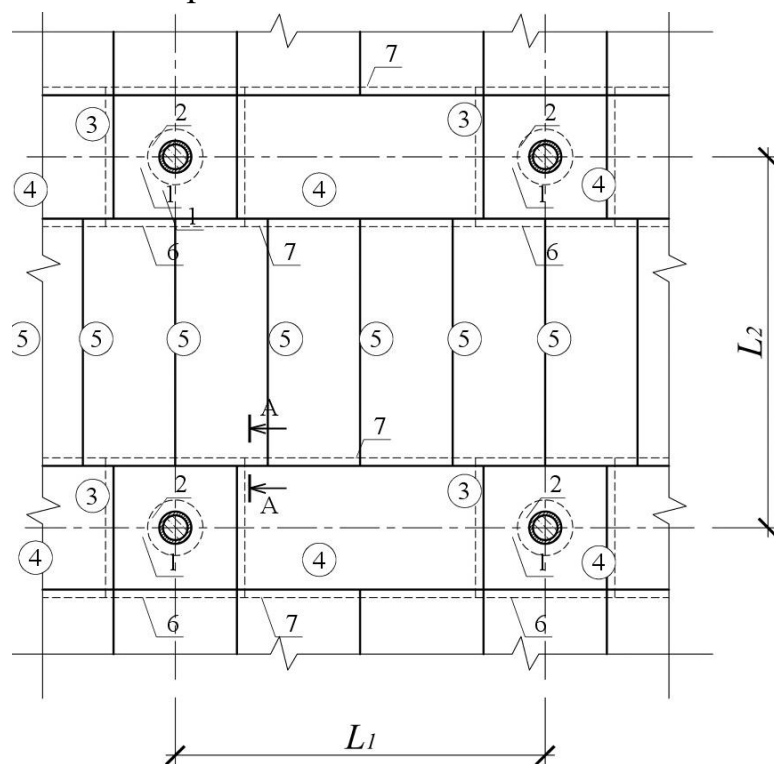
Збірне сталезалізобетонне безбалкове перекриття із пустотними плитами:
